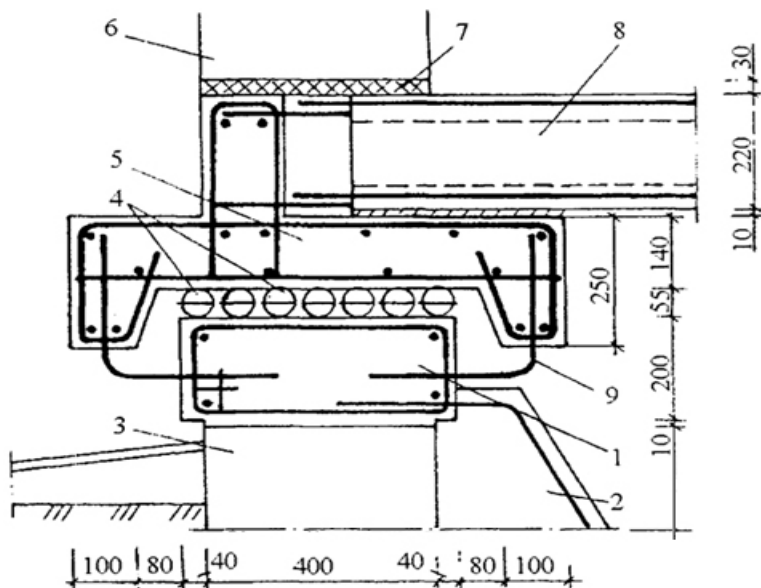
Железобетонный механизм сейсмоизоляции на сфероидах:
